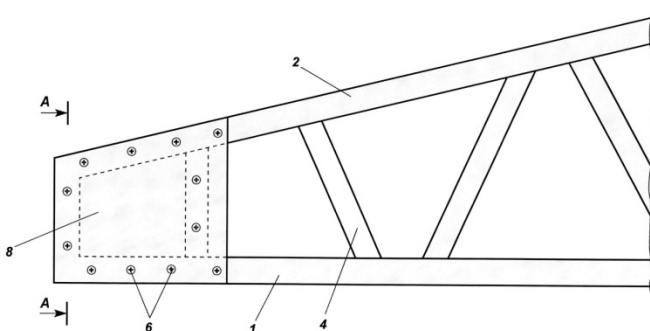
Несущий узел пространственной каркасной конструкции с установленной усиливающей пластиной [11], где: 1 - нижний пояс; 2 - верхний пояс; 4 - раскосы; 6 - саморезы; 8 - усиливающая пластина.
